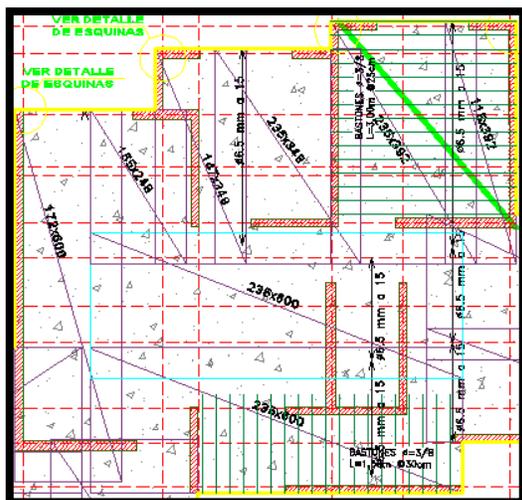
Colocación de malla en la losa. Refuerzo Inf.
